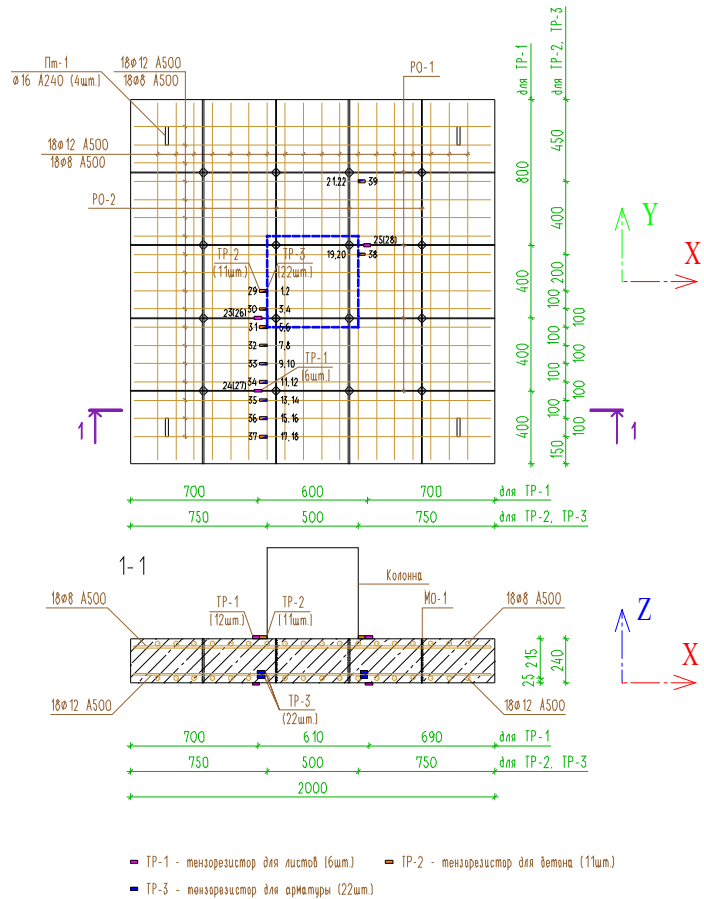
Фрагмент плиты перекрытия 5 (ФПП-5), РС65
